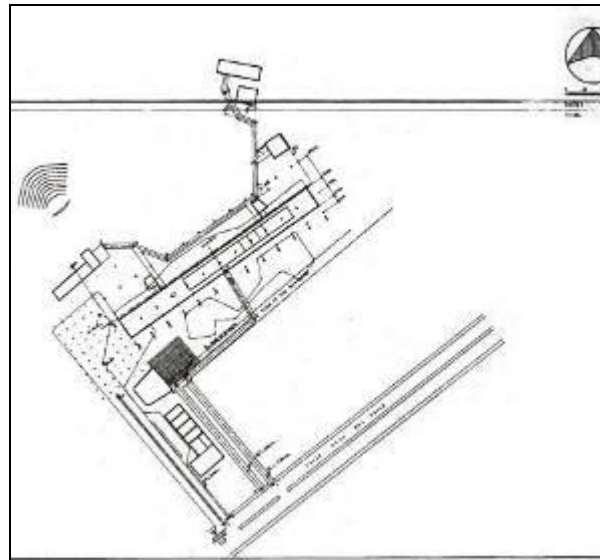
e. UH Cerro Grande. Planta baja de Conjunto. (1952)
